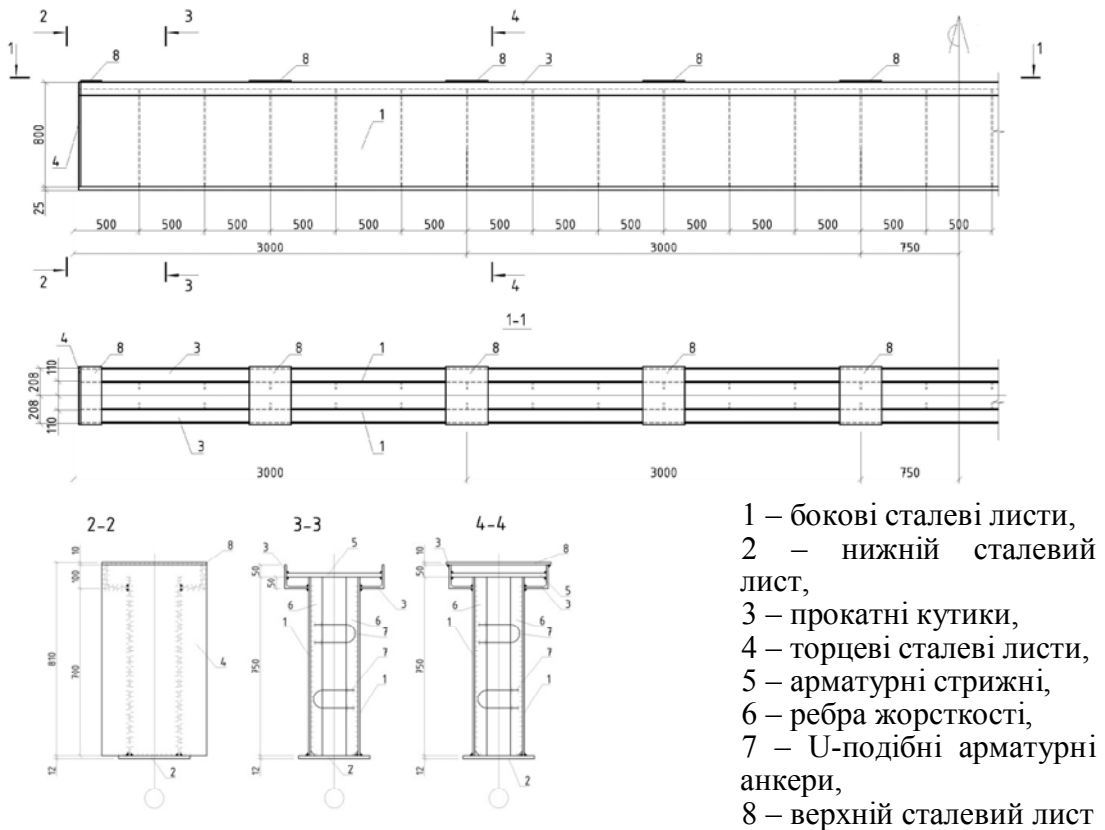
Креслення сталезалізобетонного ригеля покриття Б2
